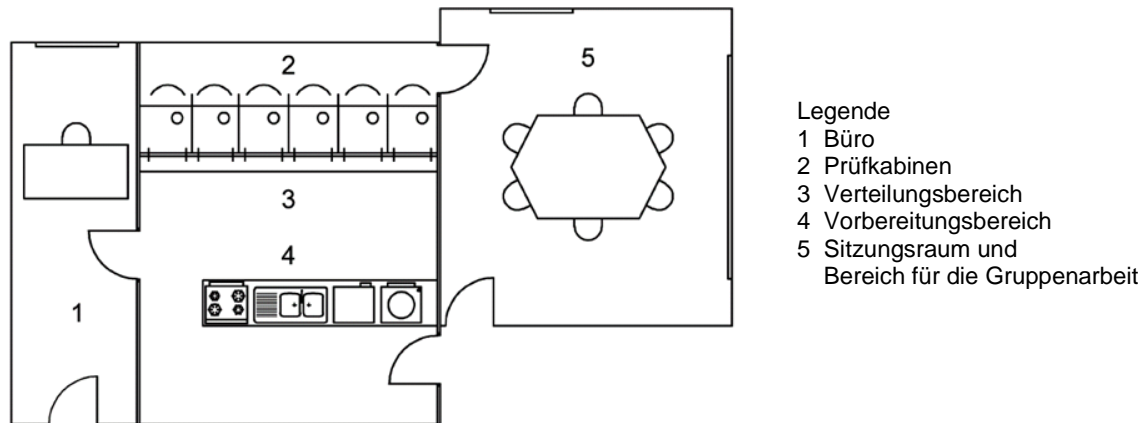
Grundriss eines Prüfraums [11, S. 14]
